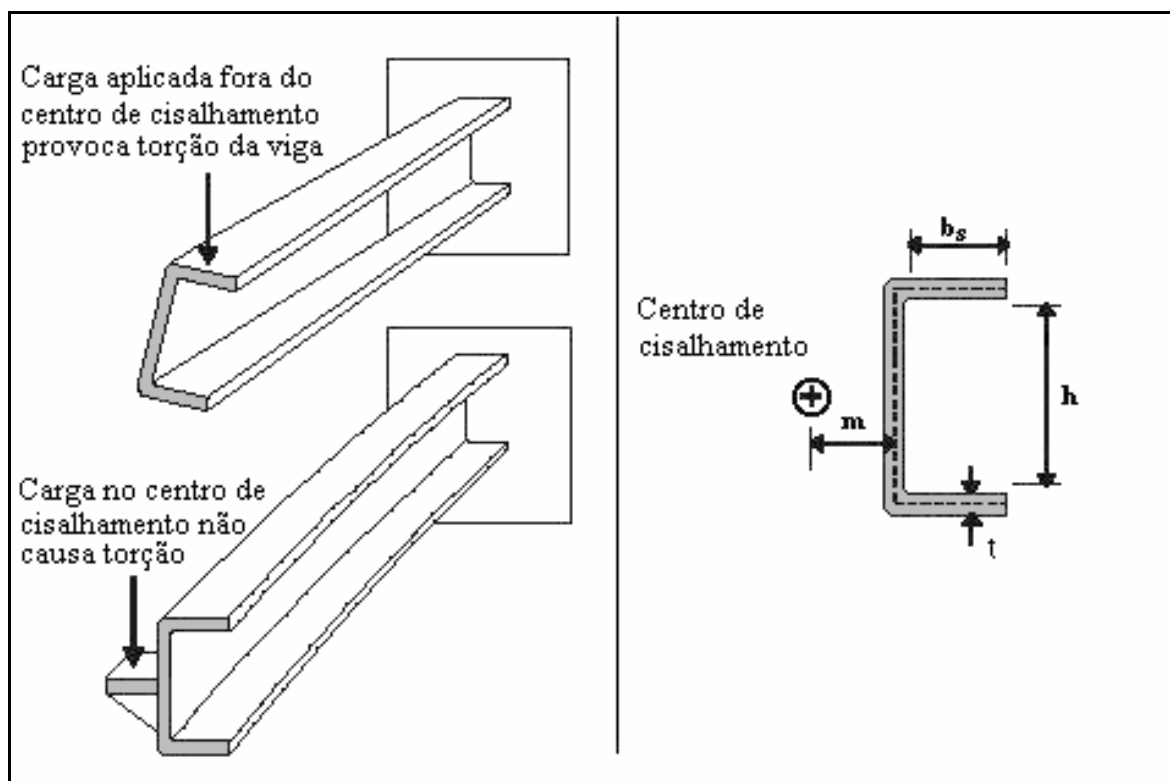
Centro de cisalhamento para uma viga com perfil tipo canal
